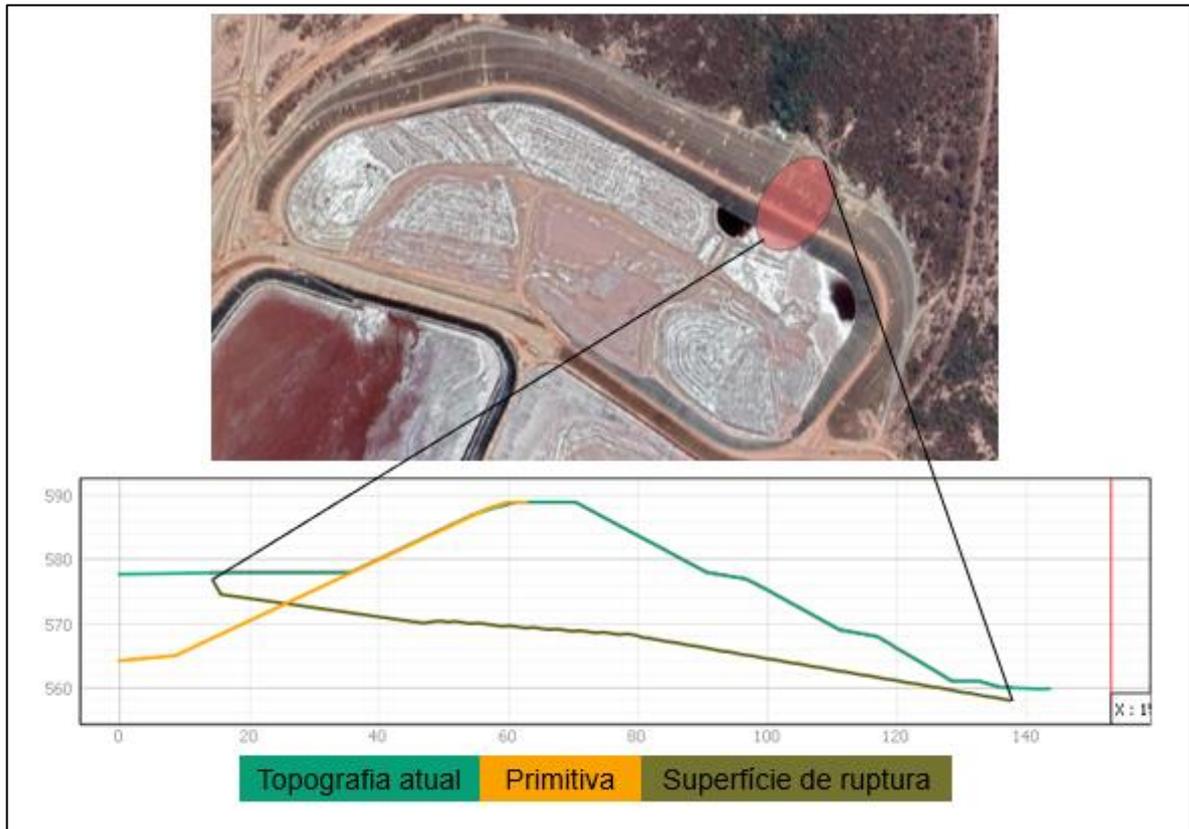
Vista em planta e perfil transversal da forma mobilizada.
